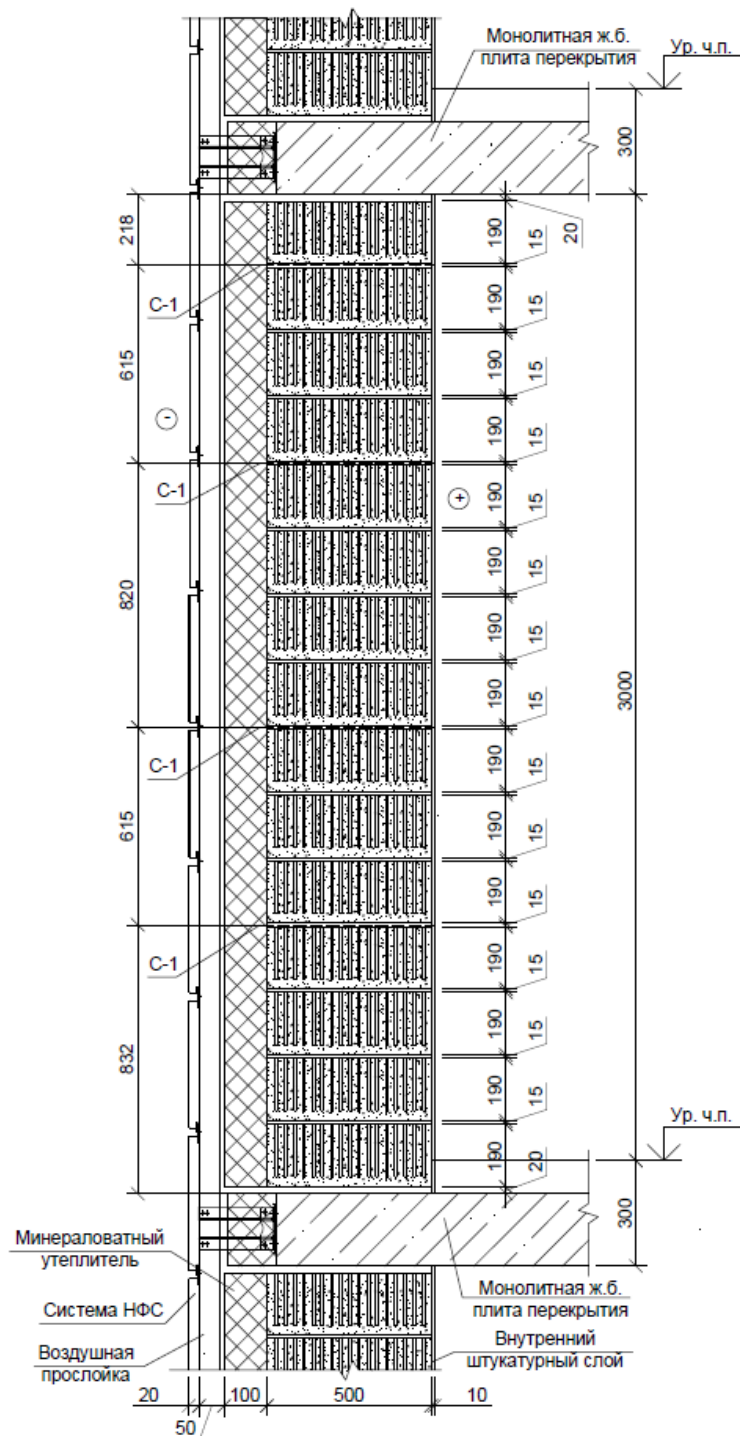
Узел крепления наружной стены к монолитному железобетонному перекрытию (разрез по стене без проема)
